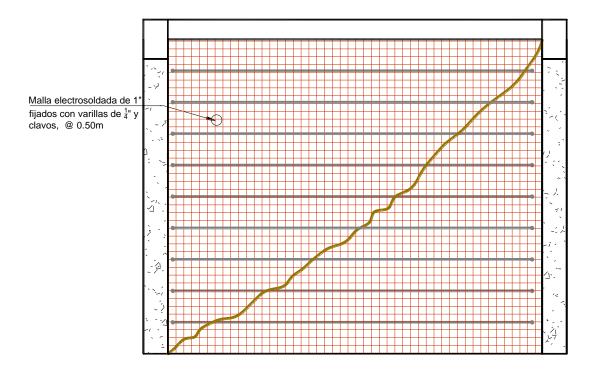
Refuerzo de muro agrietado con malla electrosoldada
